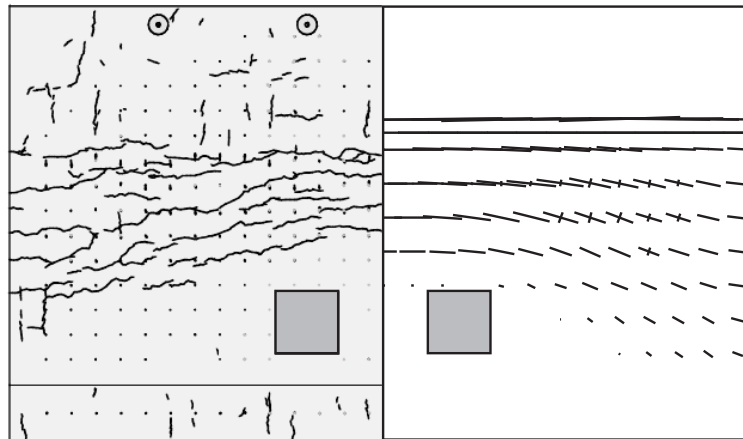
Vergleich des Rissbildes auf der Plattenoberseite nach der ersten Laststufe [97]; links: aufgenommenes Rissbild am Versuchskörper; rechts: berechnete Rissrichtungen
